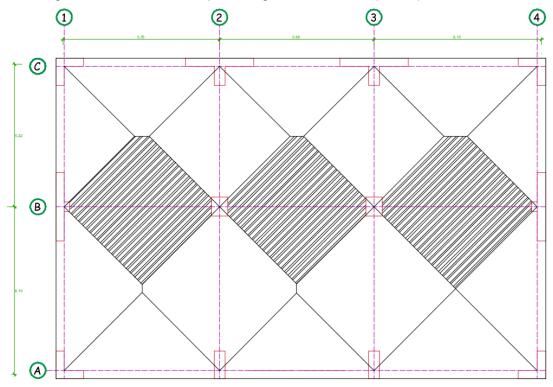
Áreas tributarias para la viga de cimentación (VC - B).
